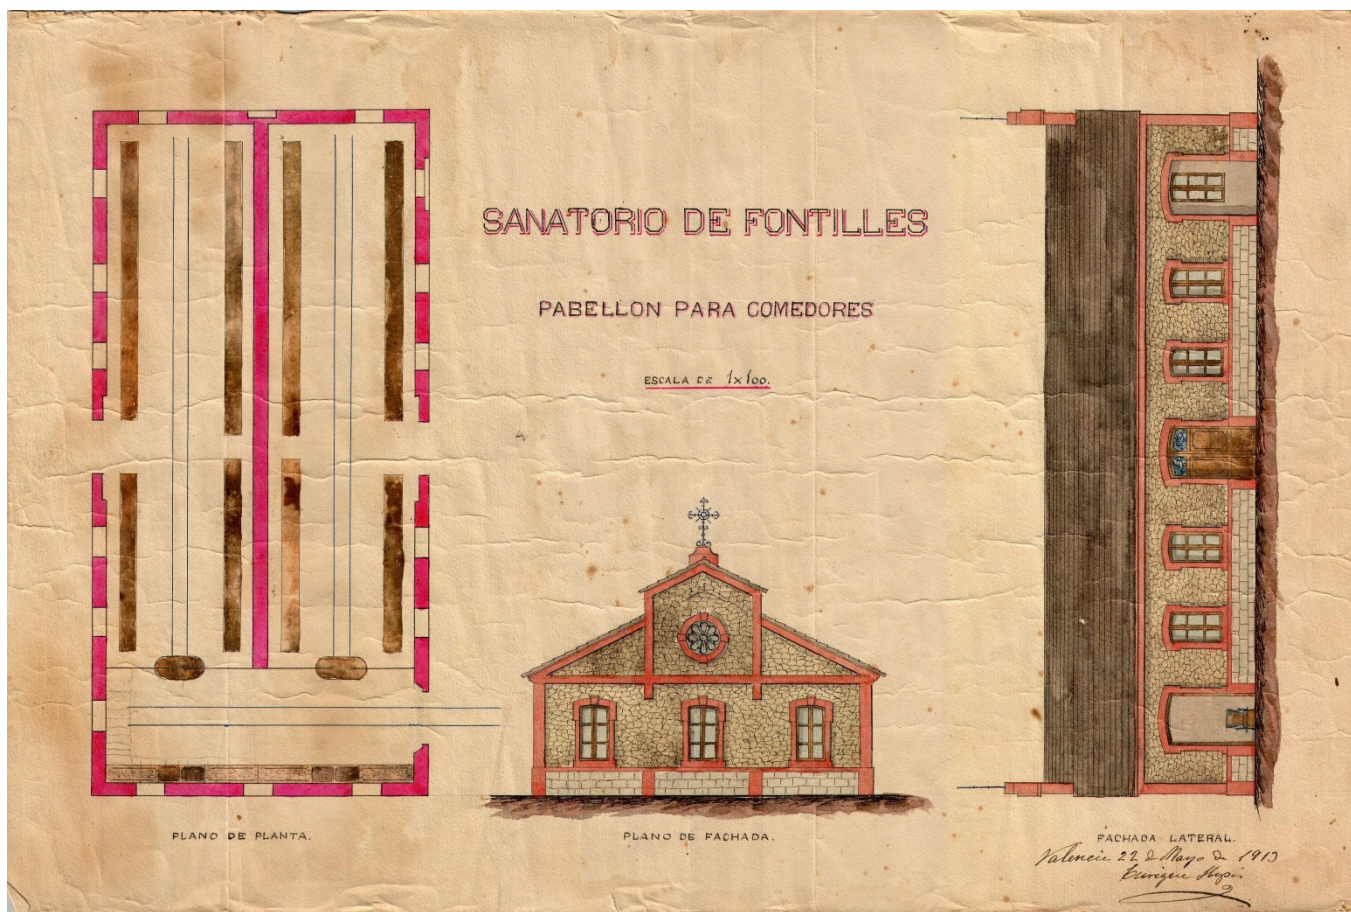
Proyecto de Pabellón de Comedores. Segunda Propuesta de Enrique Llópis, Base del Pabellón ejecutado <sup>363</sup>
